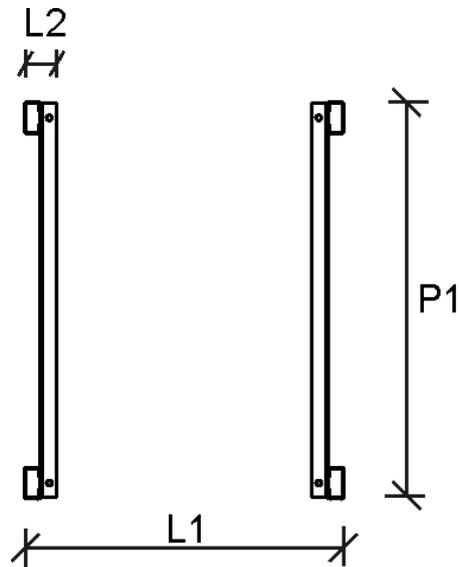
Pianta di base armadio batteria esterno Tipo 1
